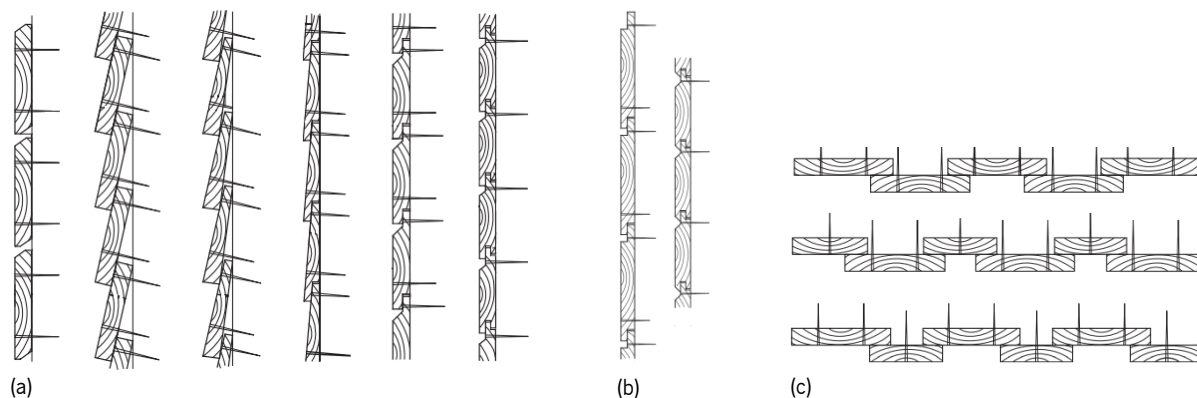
Variedade de padrões do revestimento em madeira. (a) Verticais; (b) Verticais ou diagonais; (c) Horizontais
